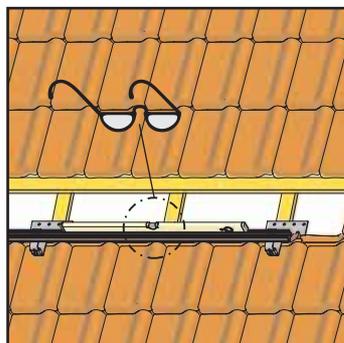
Orientare i profilati parallelamente al bordo delle tegole
